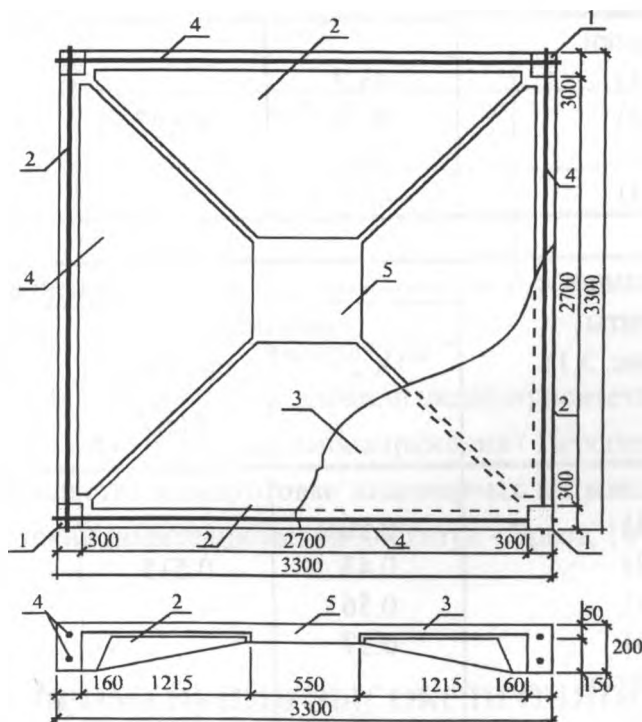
Конструкция сборно-монолитного фрагмента перекрытия
